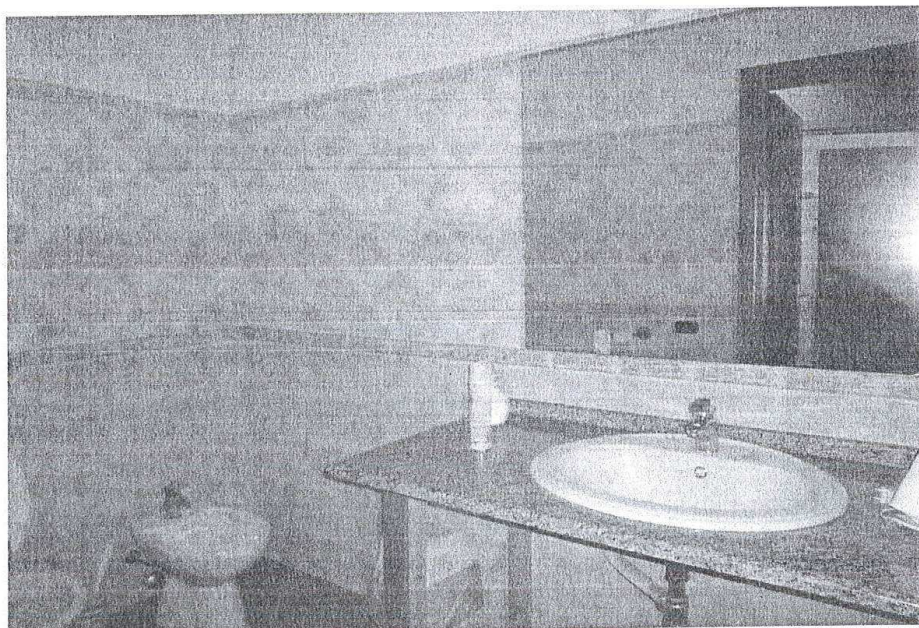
zona del bagno piano terra zona blocco uffici/servizi – precisamente wc
